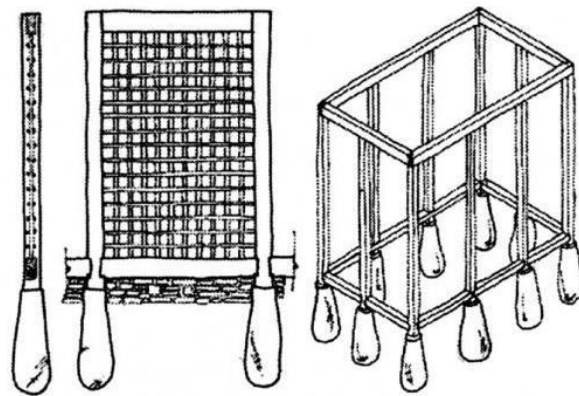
Estrutura de madeira para execução da taipa de mão.
